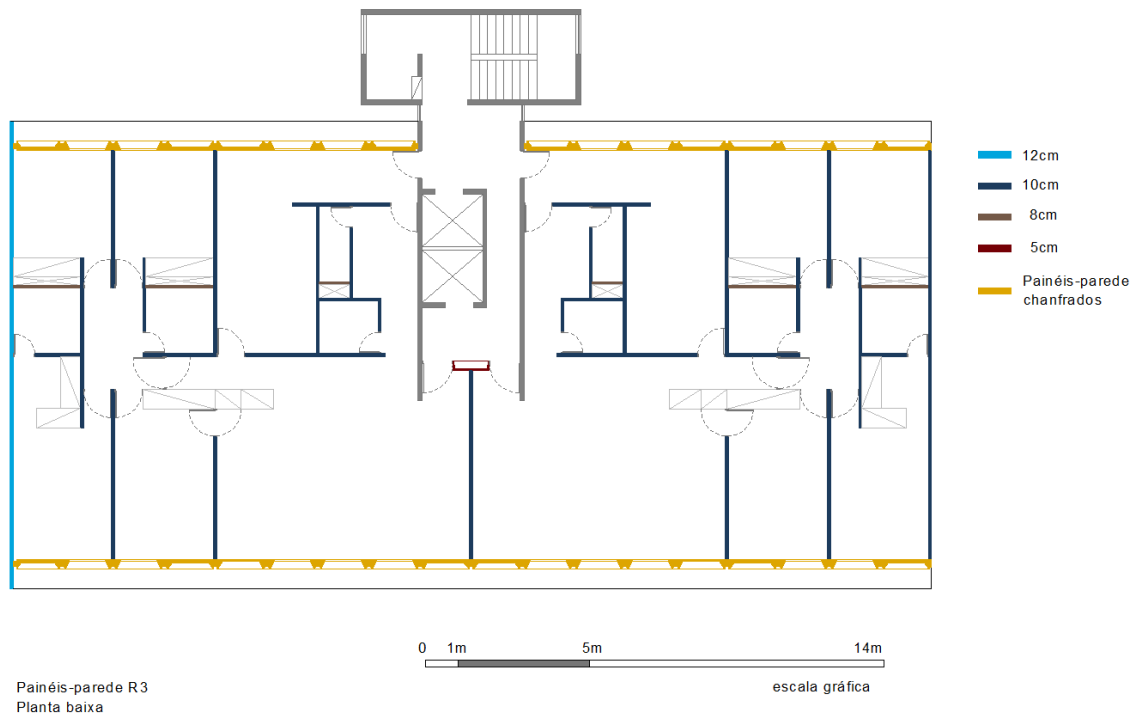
Planta com localização e espessuras dos painéis-paredes do R3. Fonte: da autora, adaptado das pranchas originais do Acervo do Arquiteto Milton Ramos.
